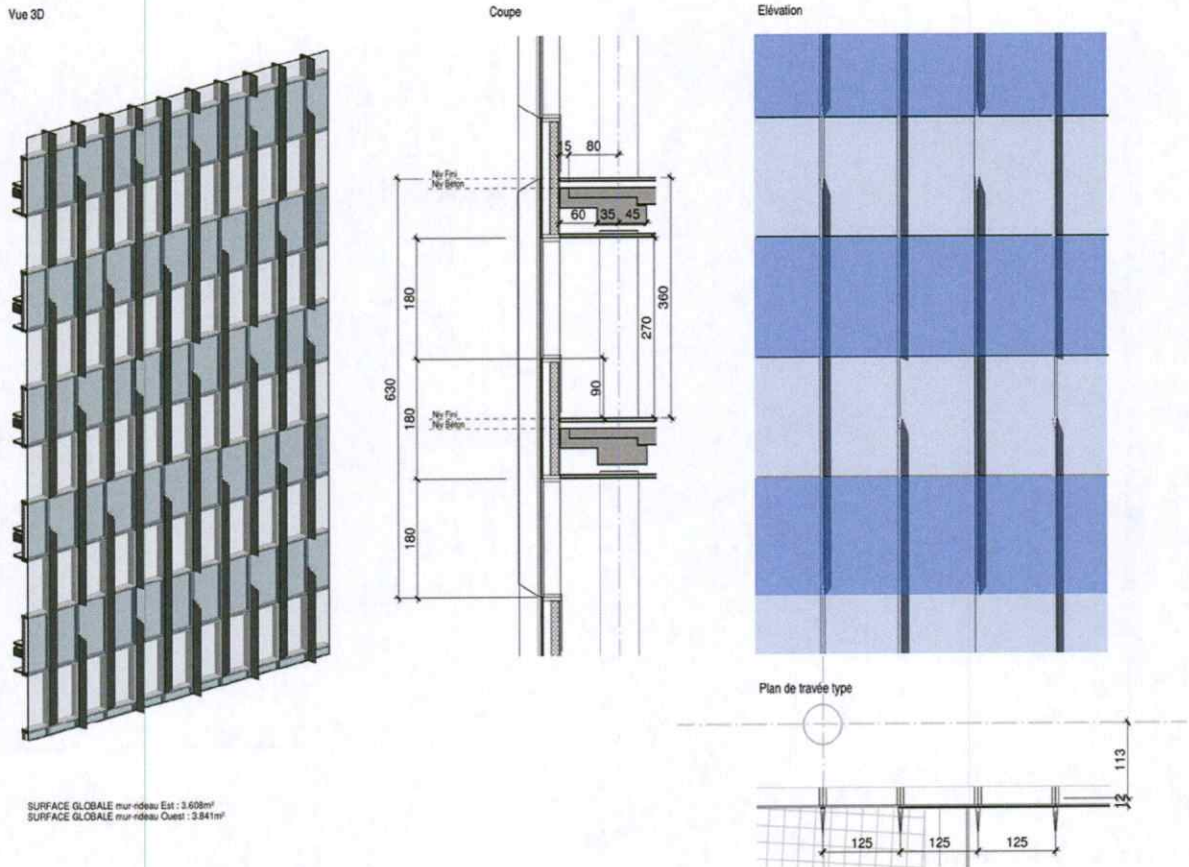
Façade EST & OUEST : traitement avec pare-soleils (extrait de la façade)
